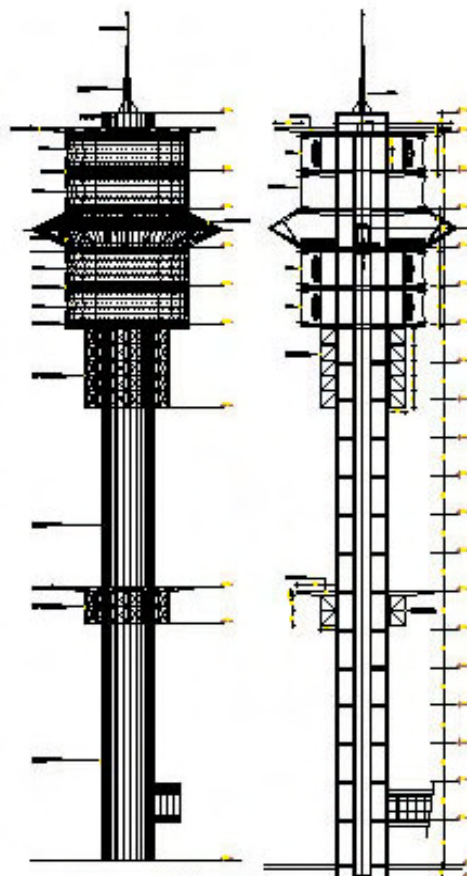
Vista e corte longitudinal da torre de concreto armado.
